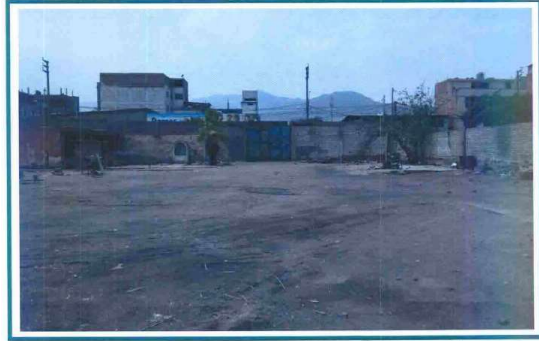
Vista panorámica donde se aprecia el interior de la zona en estudio.
